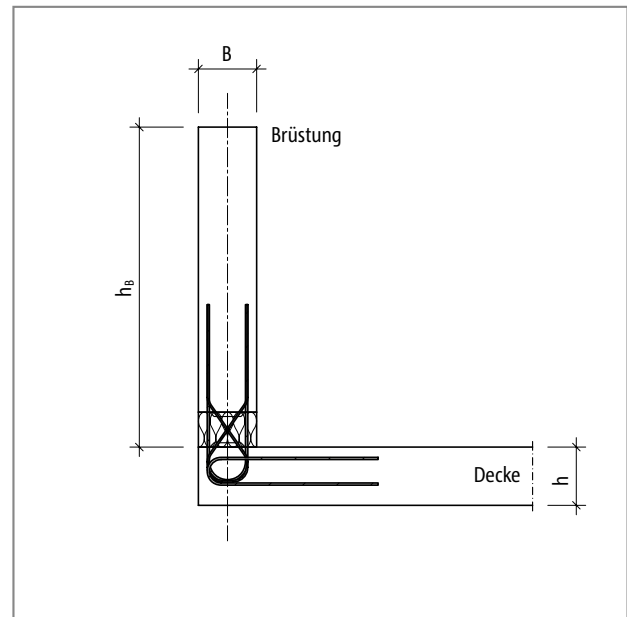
Schöck Isokorb® XT Typ A: Statisches System
